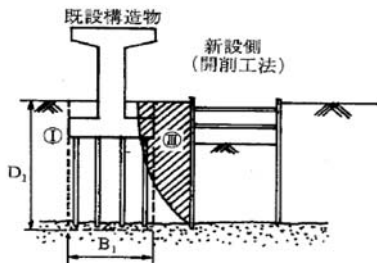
既設構造物が杭基礎の場合でも、影響範囲Ⅲと他の領域を区分する境界線が基礎底面を通る場合、または影響Ⅲにかかる領域が基礎全体の概ね 1/3 以下の場合は要注意範囲Ⅱとする。
